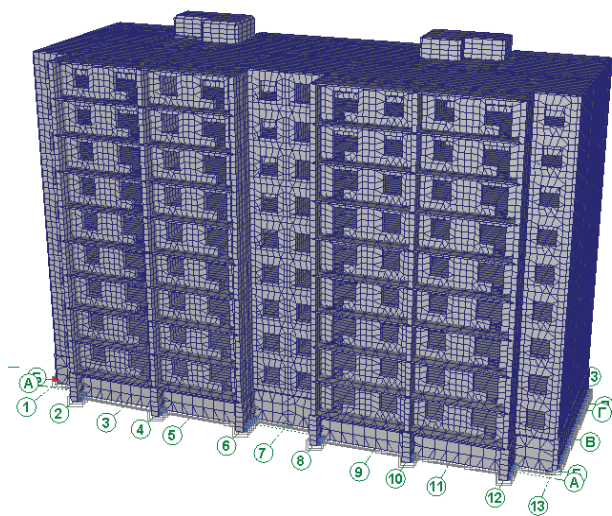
Расчетная схема 9-этажного жилого здания.
